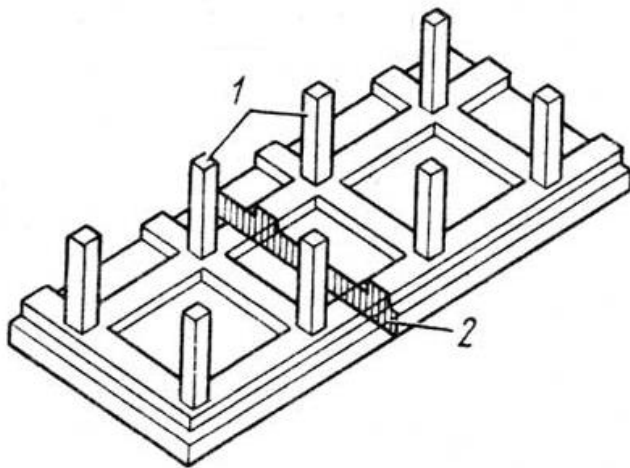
Ленточный фундамент: 1 – колонна; 2 – фундамент
